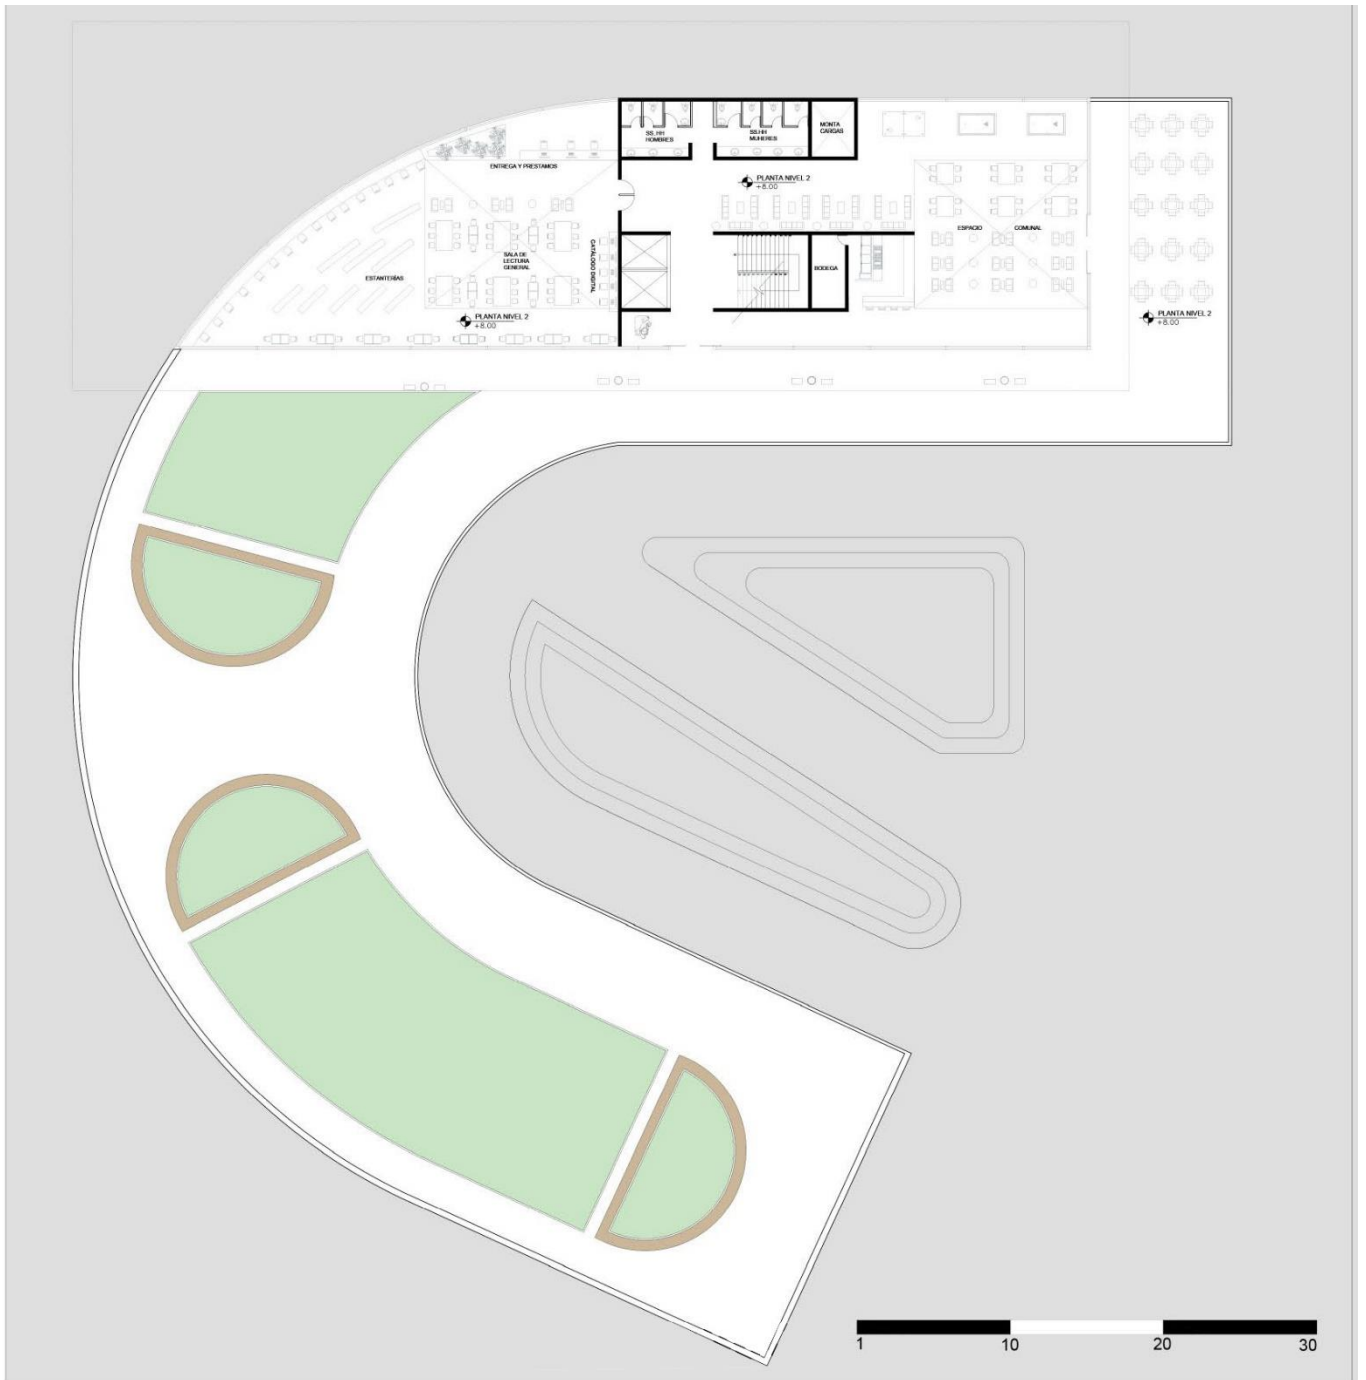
PLANTA NIVEL 2. Elaboración propia..
